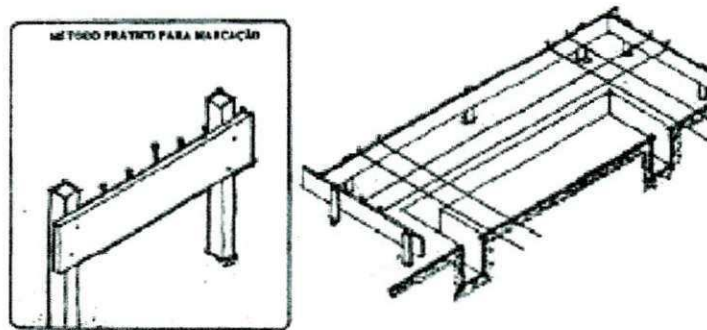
Ilustração da demarcação do eixo e das faces de um elemento a ser locado.
